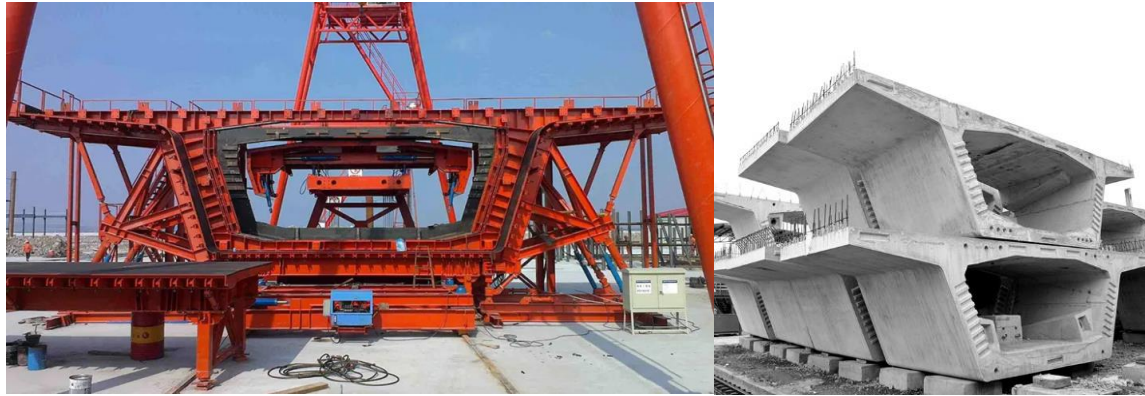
a) Encofrados metálicos de viga cajón b) tramos de viga cajón prefabricadas con ranuras de conexión (Fuente: victoryepes.blogs).
